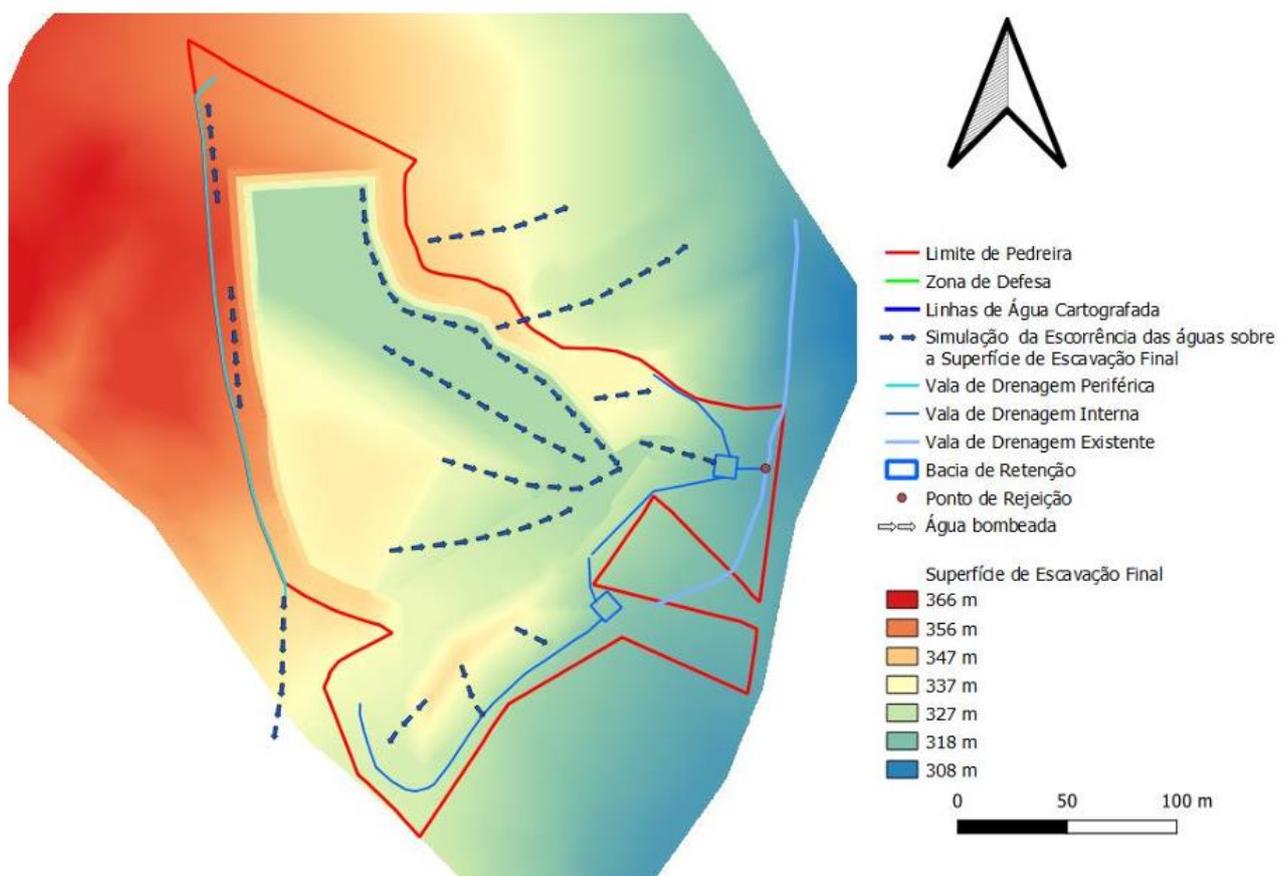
Planta de simulação do escoamento de águas sobre a superfície final de escavação.
